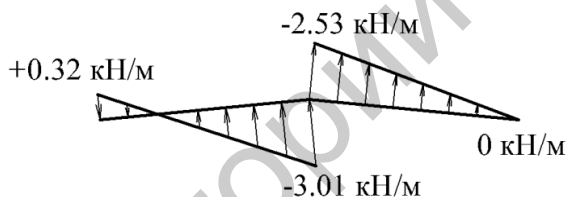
Схема загрузки ветровой нагрузкой по СНиП II-23-81
